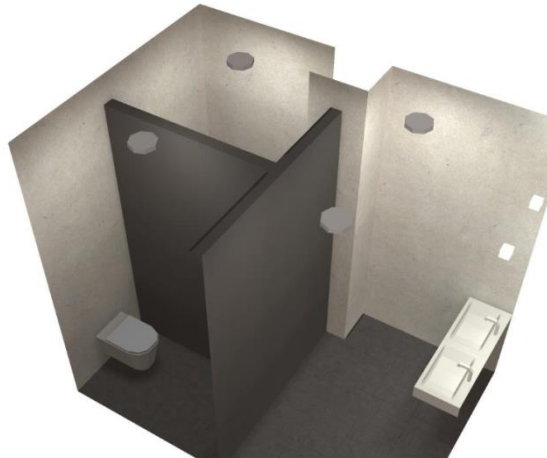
34. Render 3D bany Planta 1-2 (Font: Dialux 4.13)
